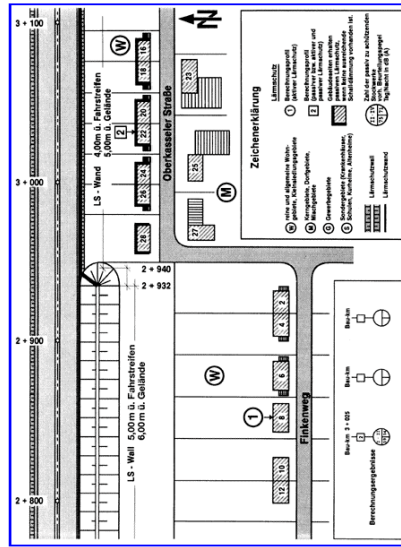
Darstellung der Lärmschutzmaßnahmen im Lageplan
